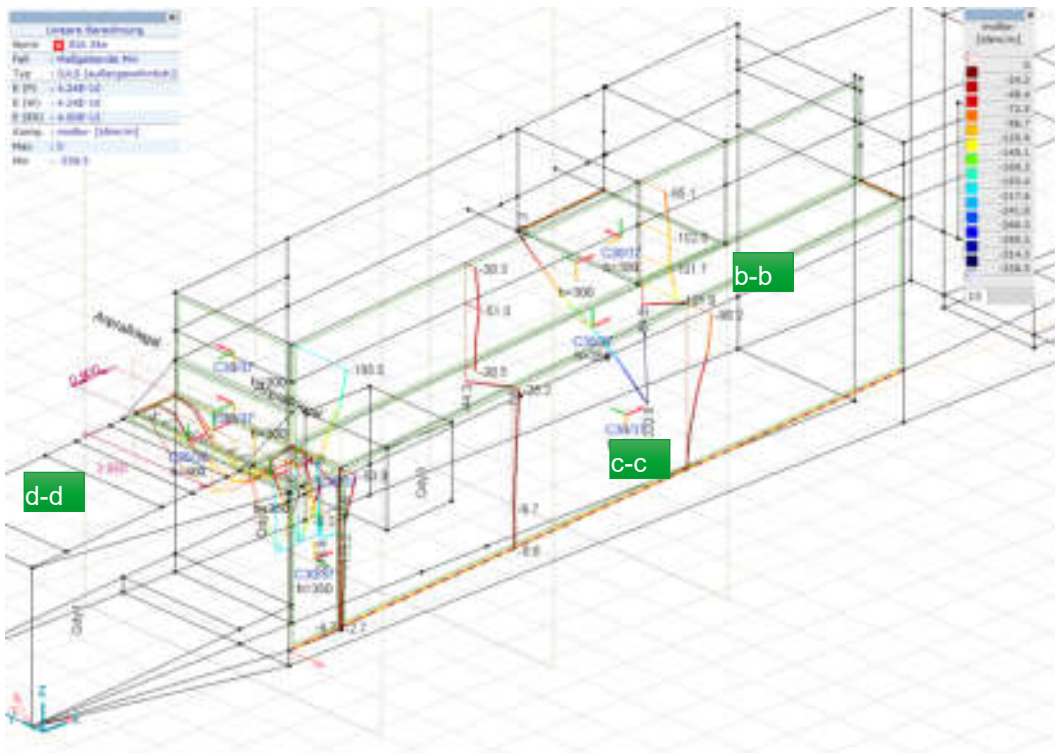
Schnitt: Brüstung horizontal aussen; Decke / Wand Längs (Verteilarmierung)
